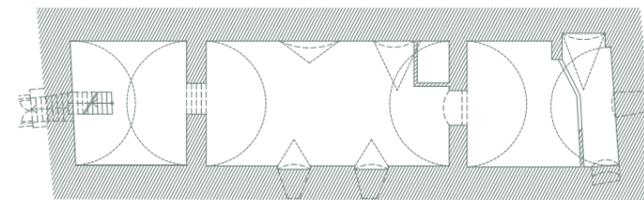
Bestandsplan, Dachdraufsicht, M 1:150
